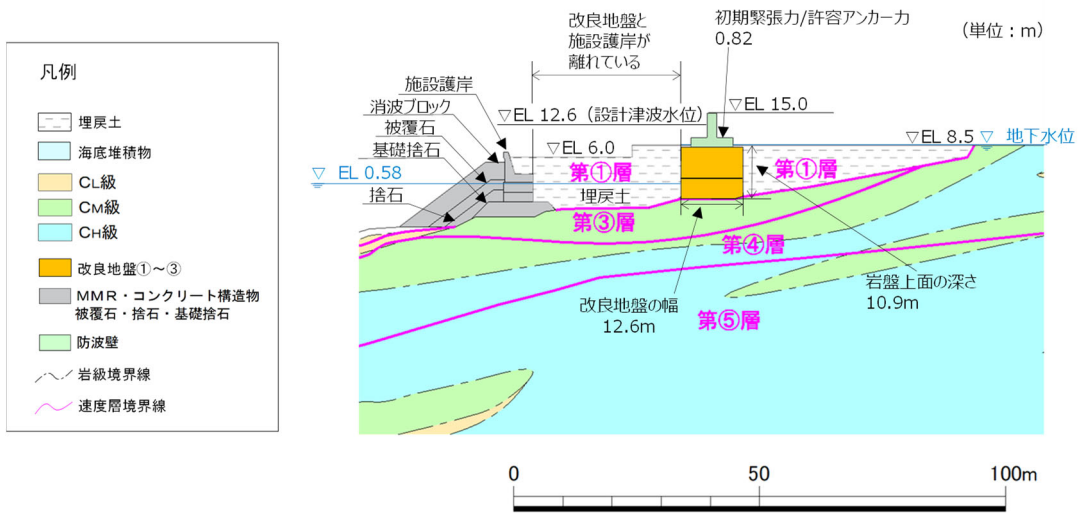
防波壁（逆 T 擁壁）の横断面図（①-①断面）
